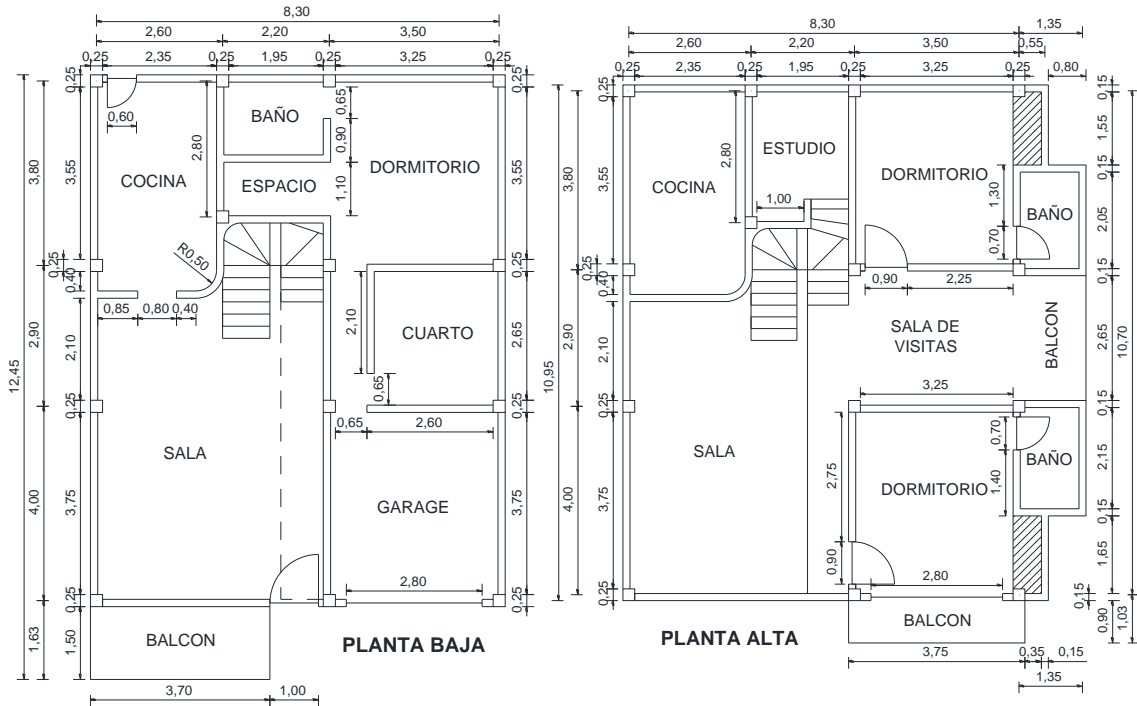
Planos Modificados – “Vivienda del Sr. Walter Santos”.
